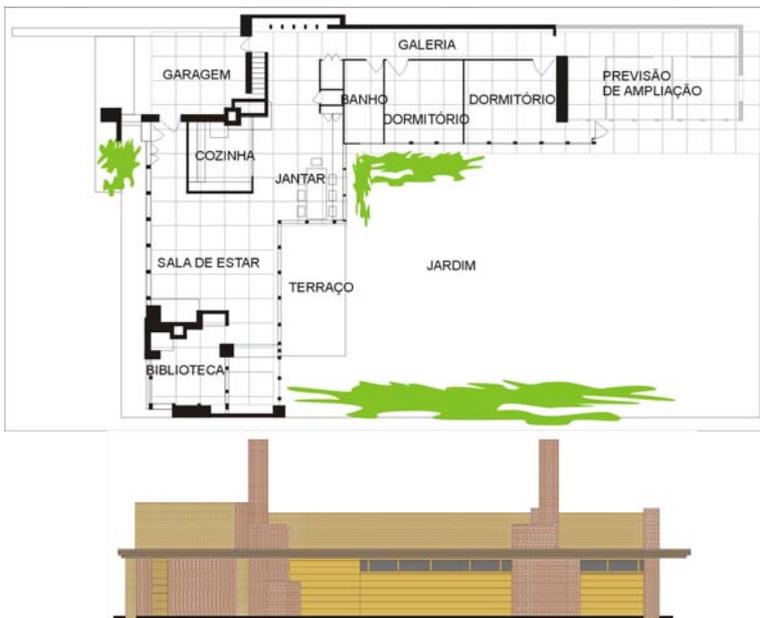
Planta e elevação frontal *Lusk House*, 1935.
